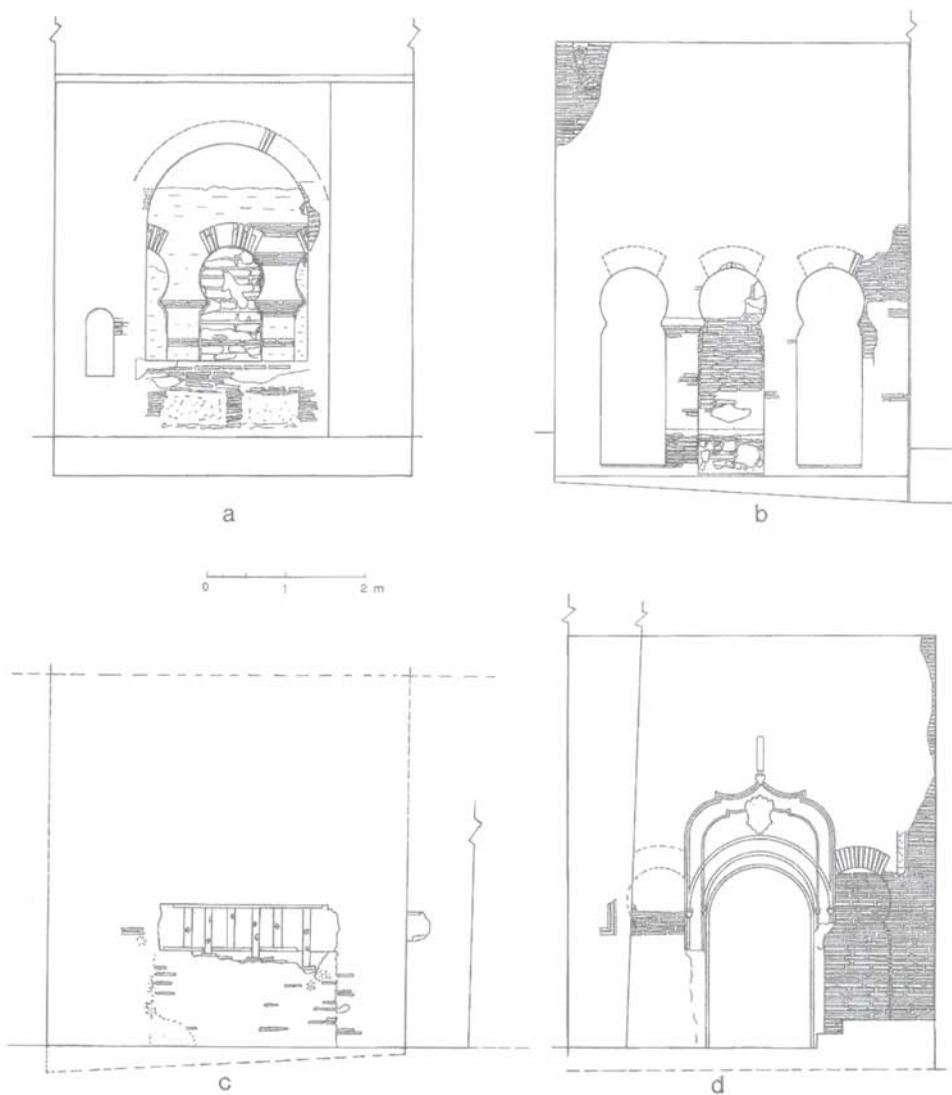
Capilla de Belén, Convento de Santa Fe, Toledo. Alzados de las cuatro fachadas del oratorio.
